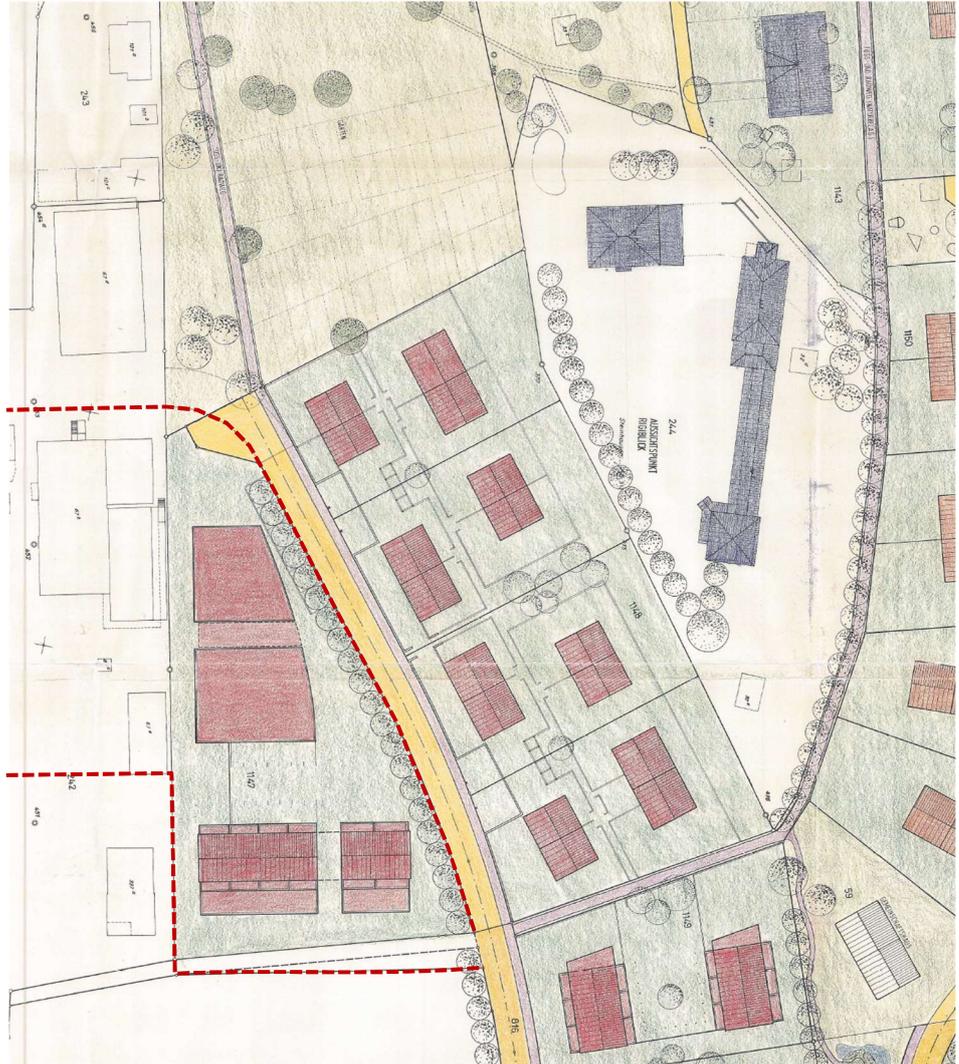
Ausschnitt Gestaltungsplanrichtplan «Schlossberg», Studienauftragsperimeter rot markiert
